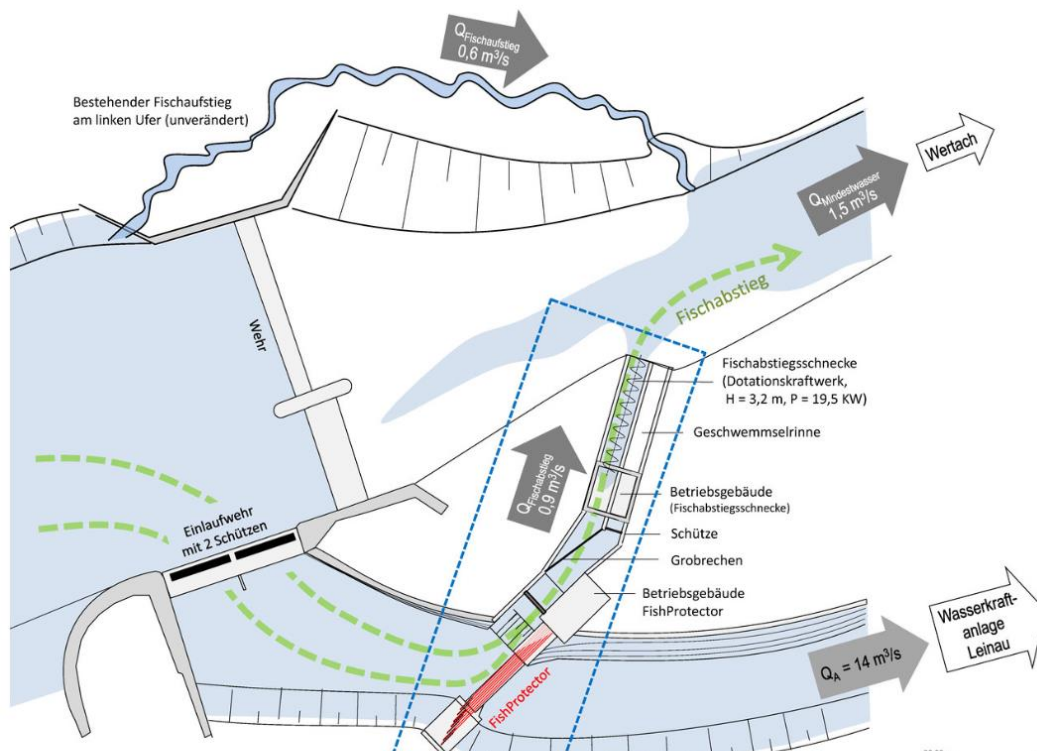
Grundriss eines Einlaufbauwerks mit elektrischer Fischeicheanlage und Bypass für einen schonenden Fischabstieg. (Hyfish GmbH)
